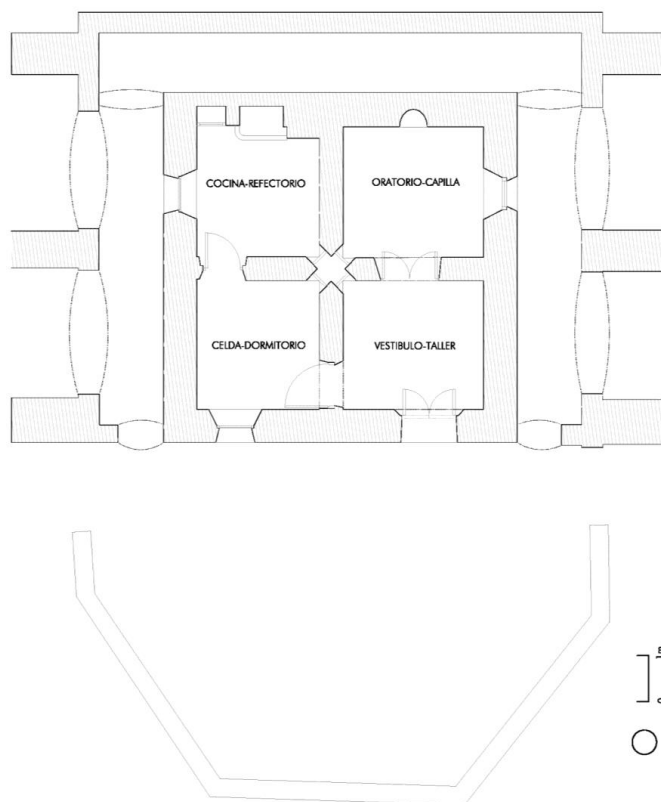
Planta original de la Ermita de Sta. Teresa de Jesús (Desierto de Las Palmas)
